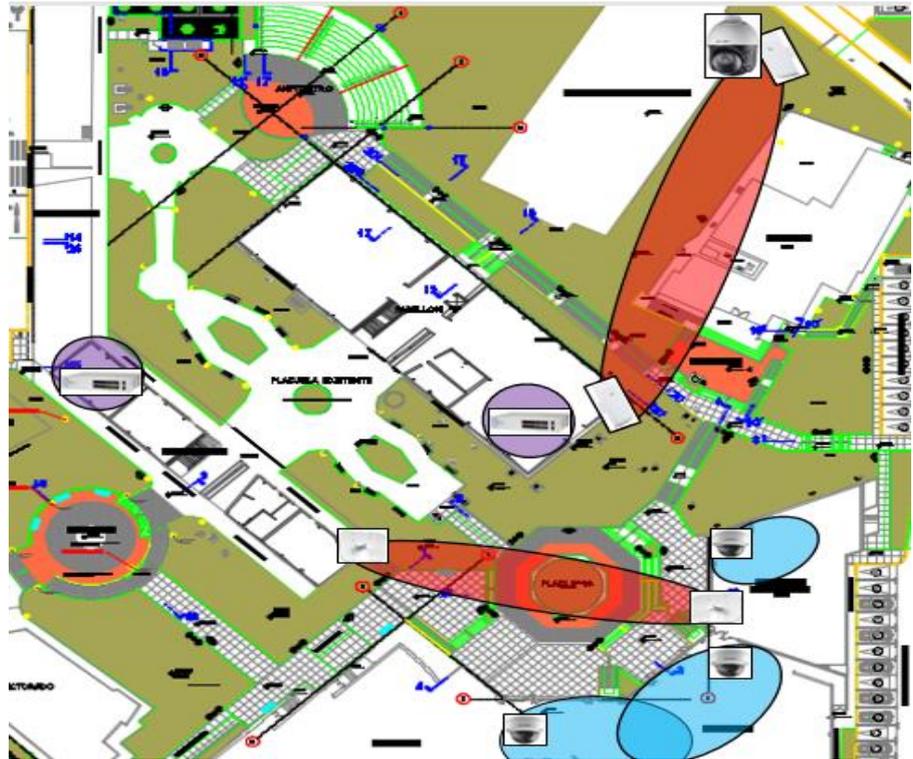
Plano de distribución de Switches para el diseño del sistema de video vigilancia.
